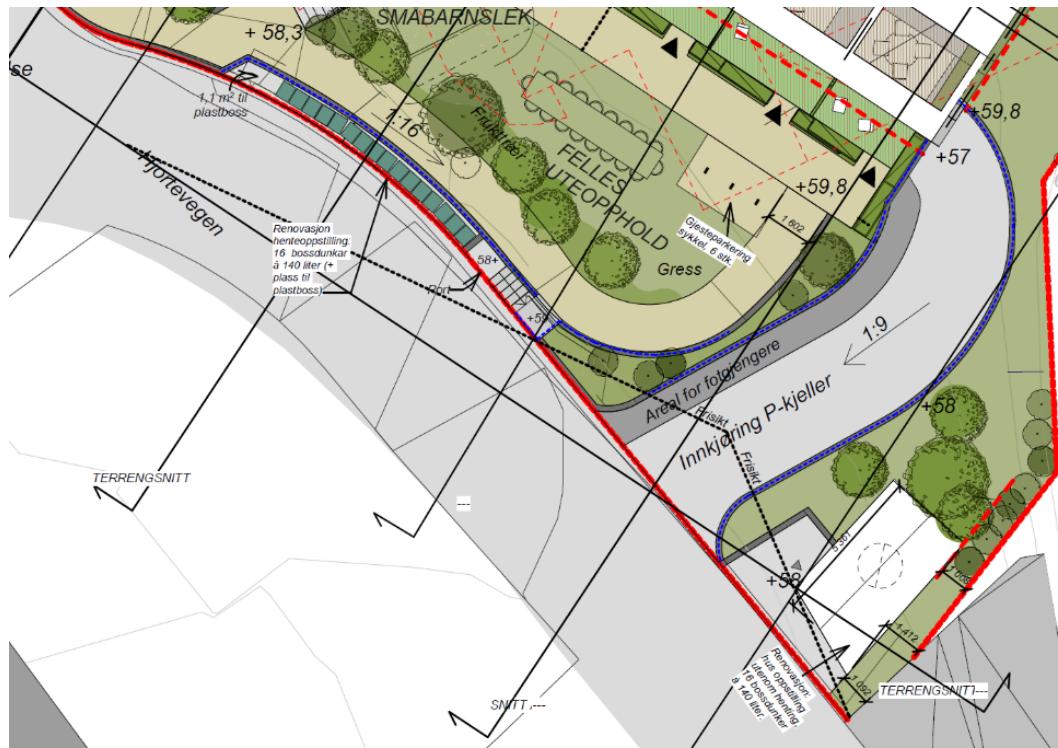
Etagjeplan og tilkomst parkeringskjellar.
